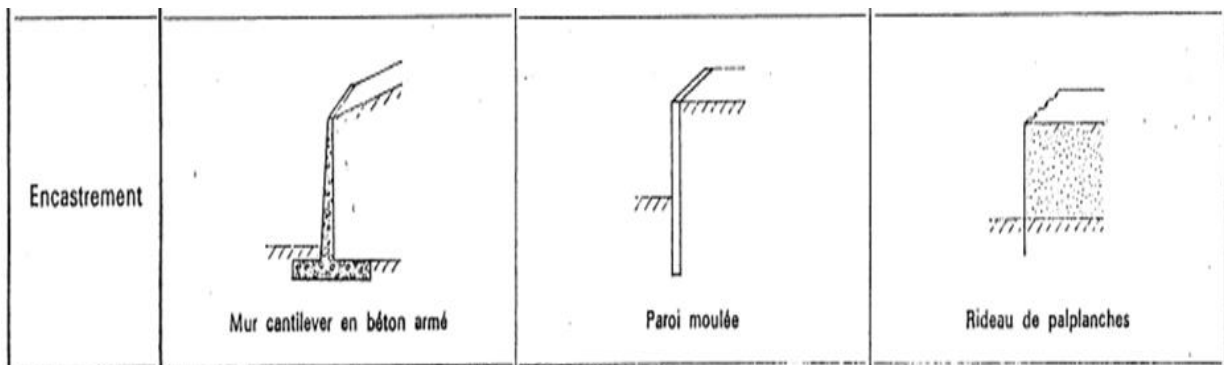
Ouvrages de soutènement rigides qui reprennent la poussée par leur encastrement
